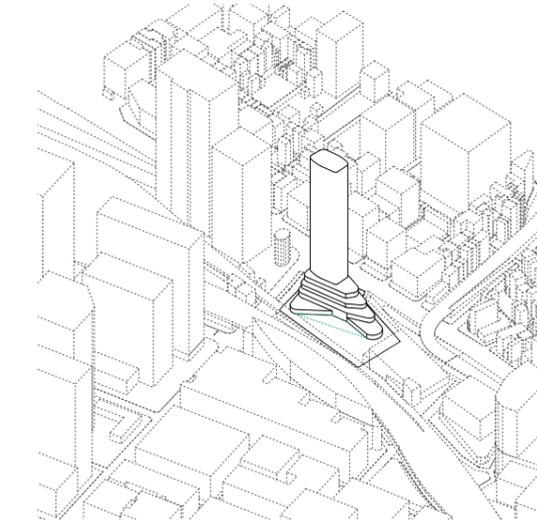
5. Bautechnische Anpassung des Hochhaus Grundrisses - Einfangen des Öffentlichen Bereichs
